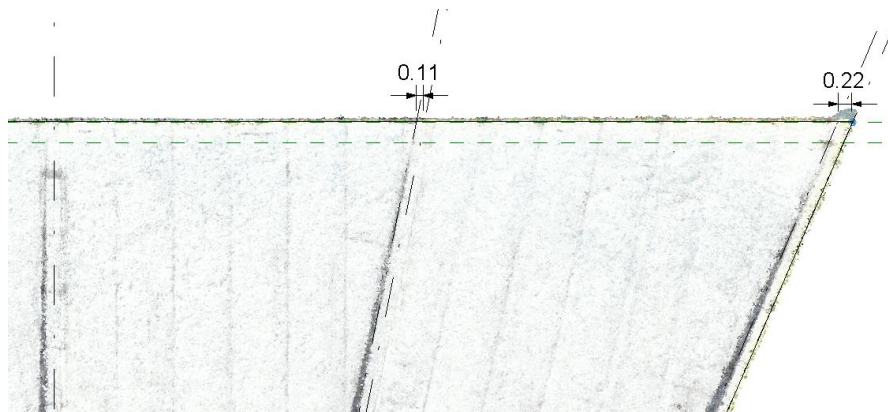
Verificação da simetria das vigas de cobertura. Fonte: Autor.
